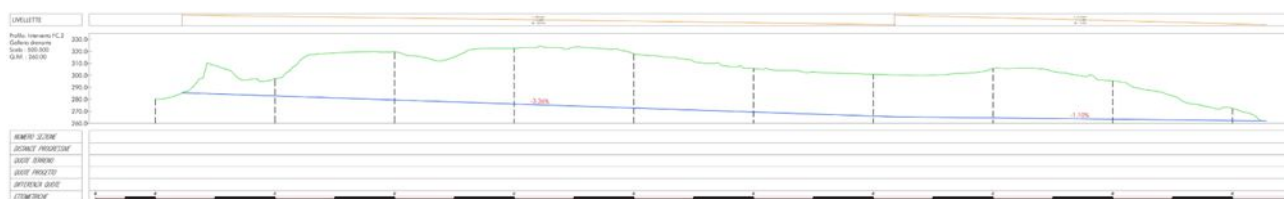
Sezione tipologica del versante in frana con galleria drenante profonda nelle argille.
